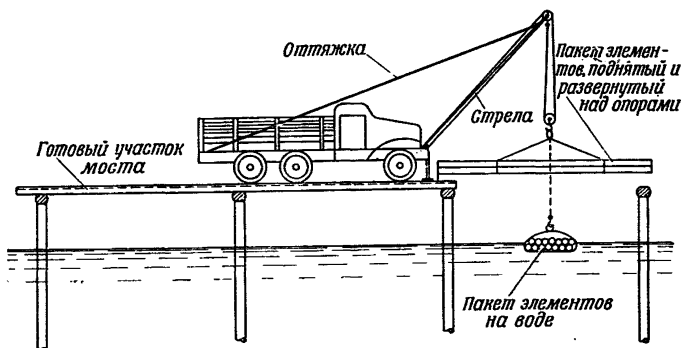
Схема укладки элементов пролетного строения на опоры грузовой стрелой, установленной на автомобиле
